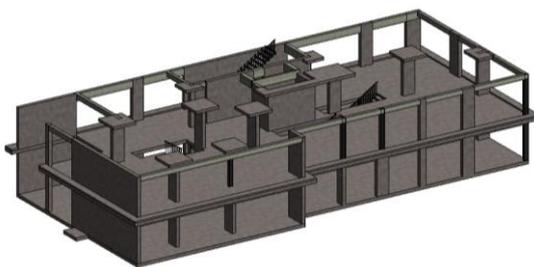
Exemplo da modelação dos vários elementos estruturais.
